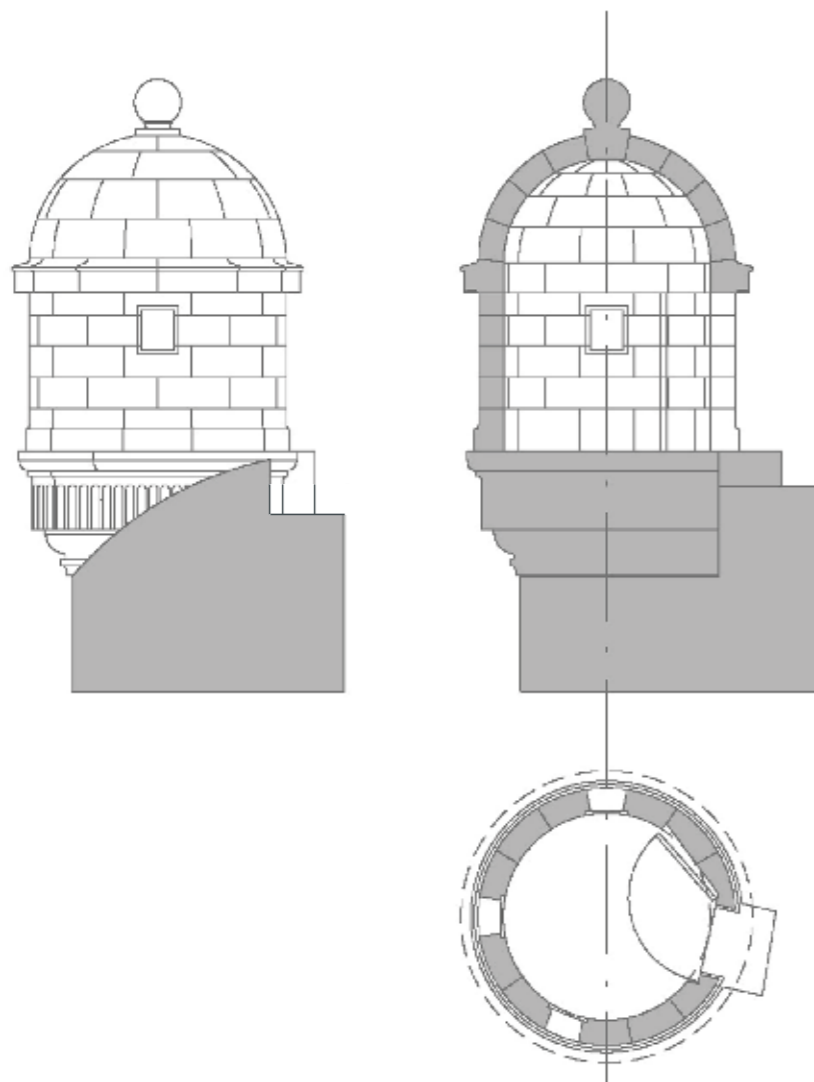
Alzado, sección y planta de la garita. Proyecto de restauración. (Balaguer 2010).
